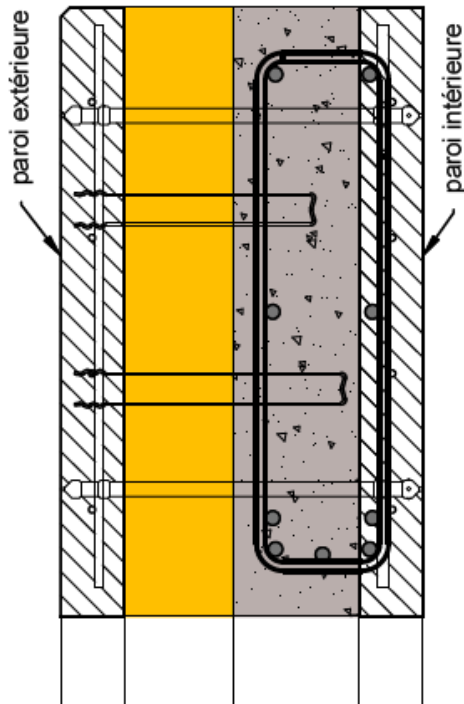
Exécution du ferrillage d'une poutre dans les murs 2000+ COMFORT
